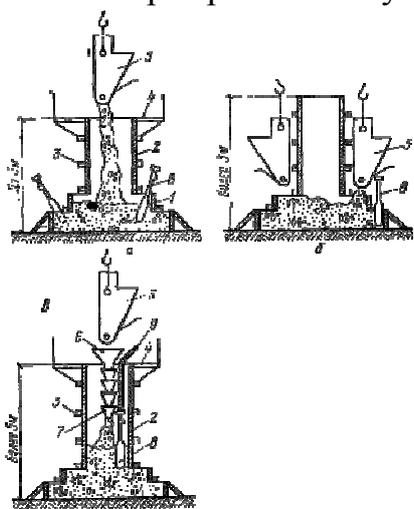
Схемы бетонирования ступенчатых фундаментов: а — высотой до 3 м; б, в — высотой более 3 м; 1 — опалубка ступени; 2 —
